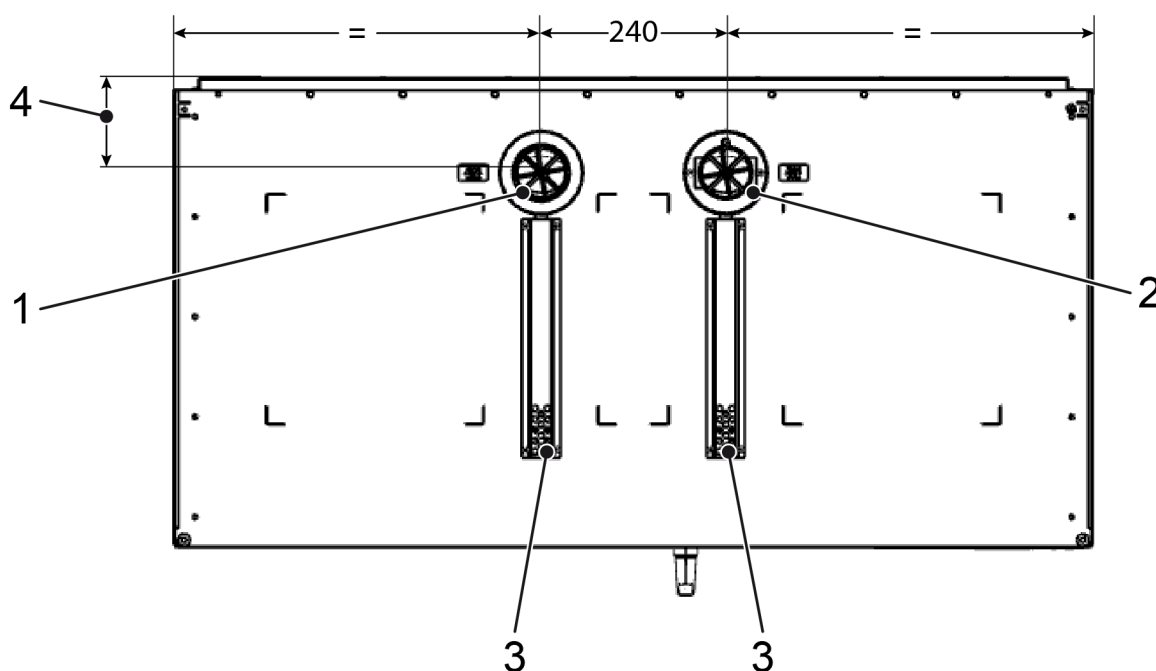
Sistema di scarico dell'aria (vista dall'alto)
